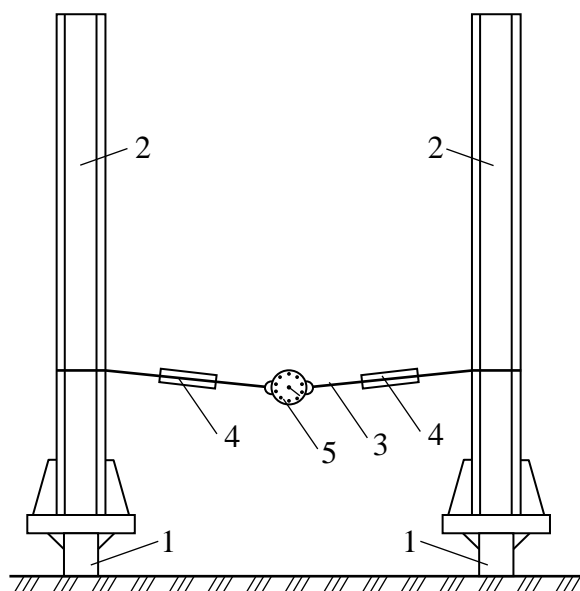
Випробування фундаментів на дію моментного навантаження: 1 – опора; 2 – щогли; 3 – трос; 4 – тальреп; 5 – динамометр
